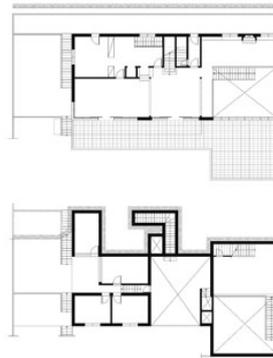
Abaixo, planta do nível Serviços e Sala de música. Acima, planta do nível Salas de estar, jantar e fumoir.
